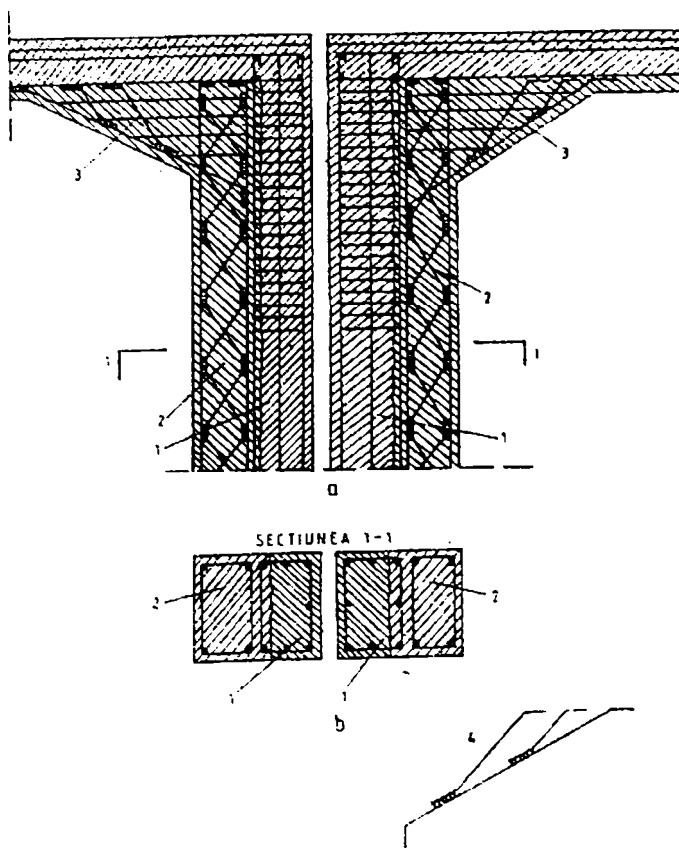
Consolidare stlpilor cu vute intermediare; a- sectiune longitudinala; b- sectiune 1-1. 1-stilp existent; 2-stilp nou turnat; 3-vuta de beton armat; 4- amaturii in vuta.
